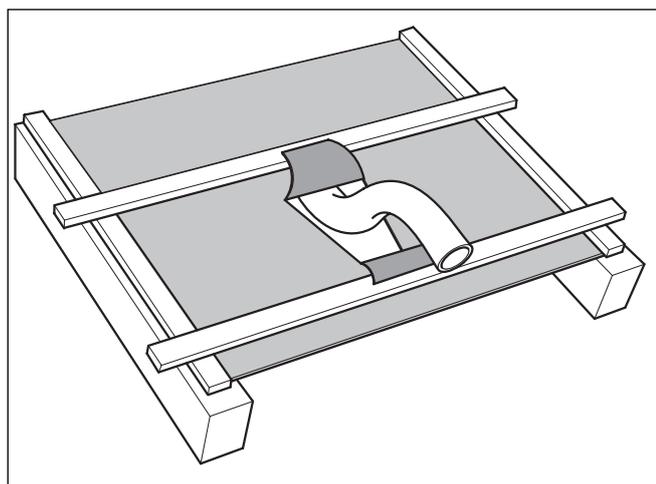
Guidage du tube à travers la membrane de sous-toiture (si elle existe)
